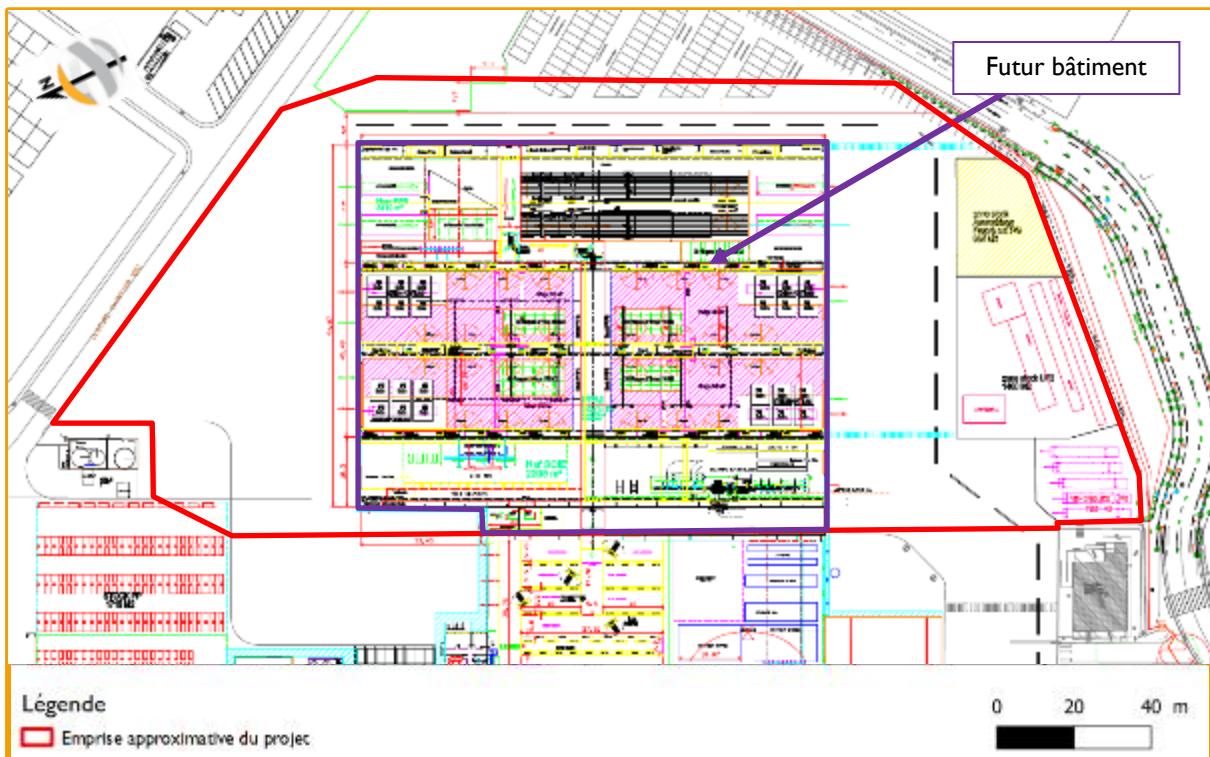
Plan de masse du projet d'aménagement (source : Les Chantiers de l'Atlantique, daté du 23/10/2021)
